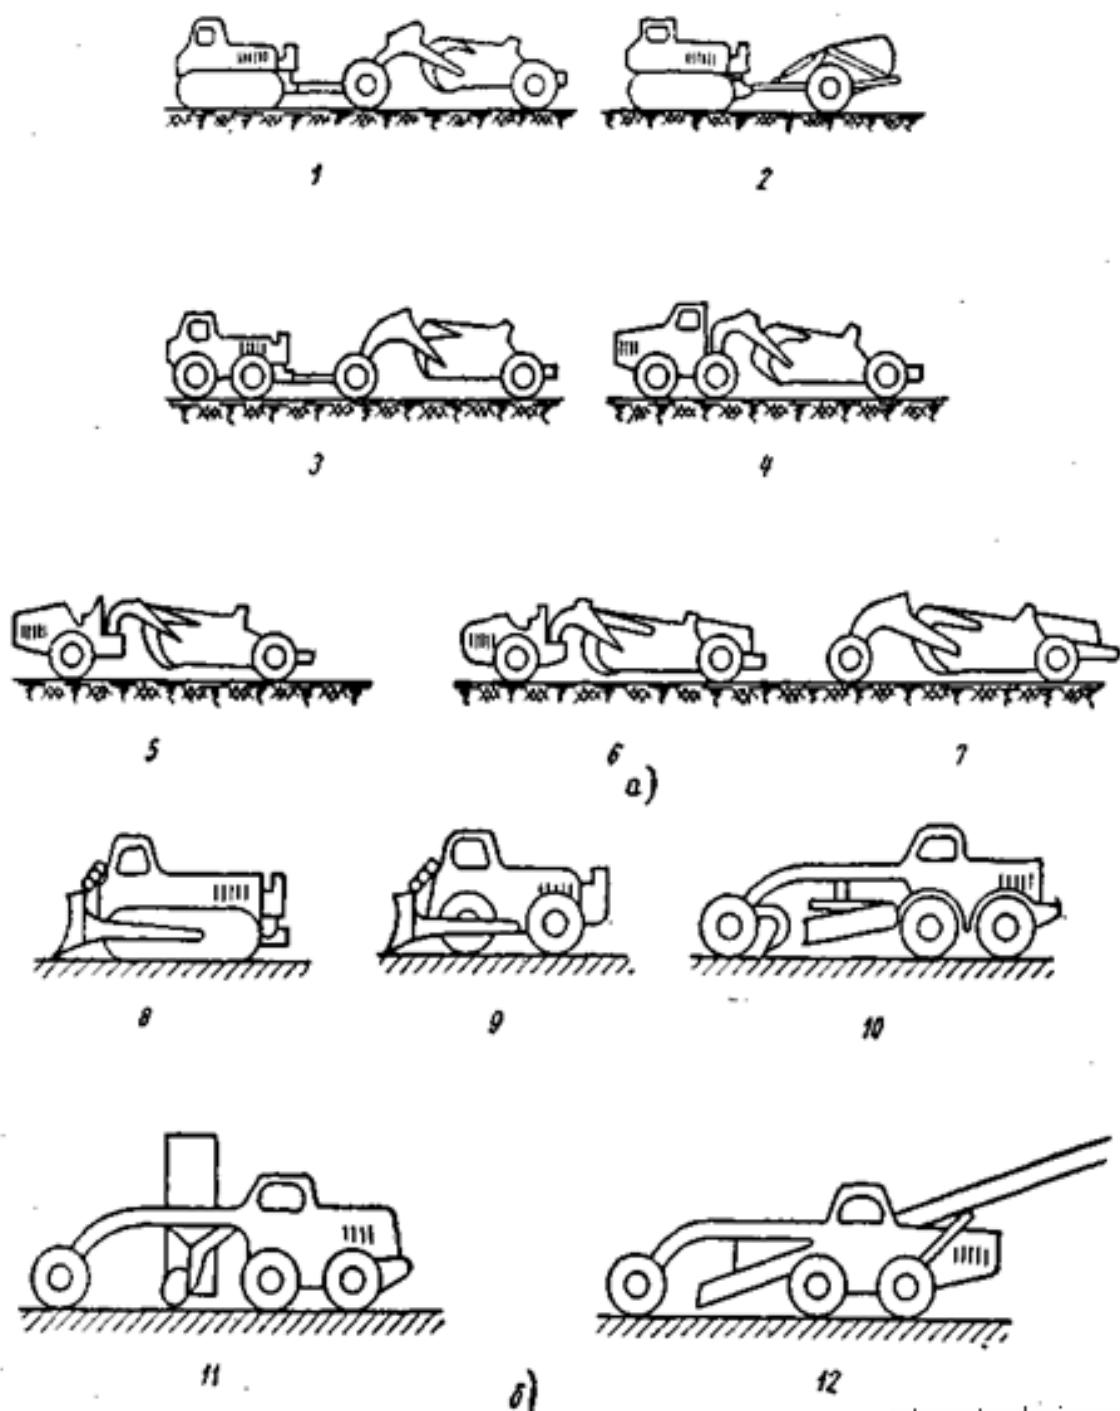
Схемы землеройно-транспортных машин: а) – ковшовые; б) – ножевые; 1 – скрепер прицепной двухосный гусеничный; 2 – скрепер прицепной одноосный; 3 – скрепер прицепной двухосный колесный; 4 – скрепер полуприцепной одноосный с колесным двухосным (седельным) тягачом; 5 – скрепер полуприцепной одноосный с одноосным тягачом; 6 – скрепер полуприцепной с одноосным тягачом с дополнительным двигателем, для привода задней оси; 7 – скрепер колесный самоходный; 8 – бульдозер гусеничный; 9 – бульдозер колесный; 10 – автогрейдер; 11 – грейдер – элеватор; 12 – диагональный грейдер – элеватор (струг)
